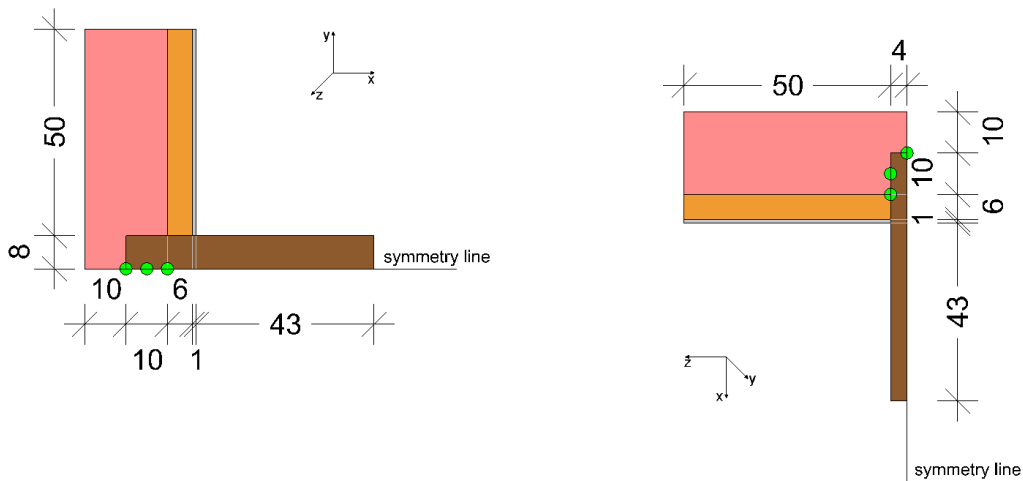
Dicken der Schichten: links Vertikalschnitt, rechts Grundriss
